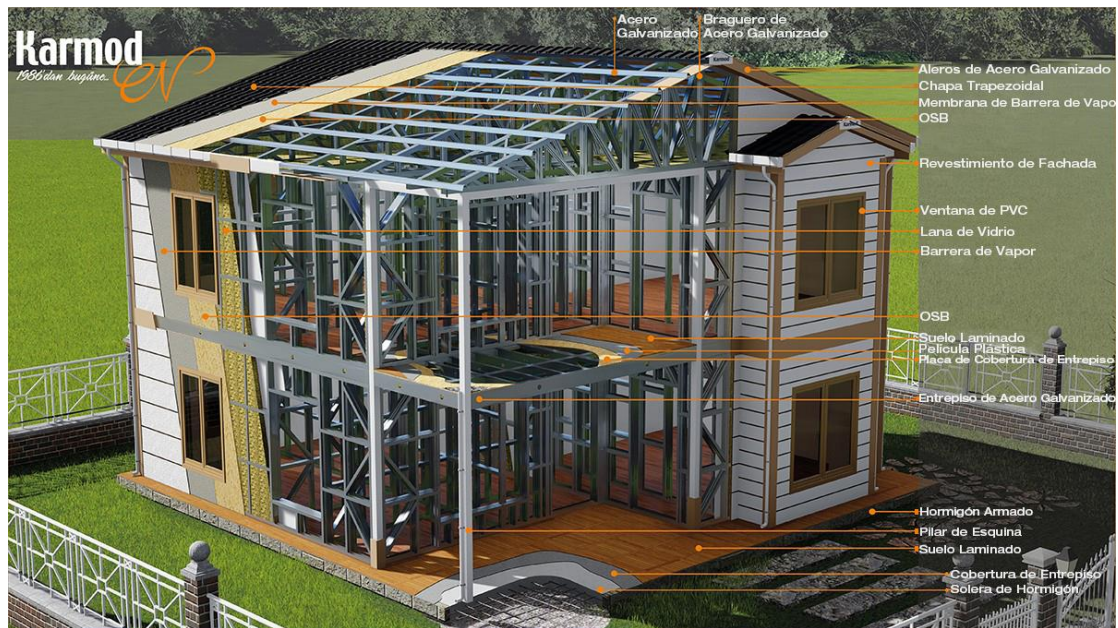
Estructura de una vivienda prefabricada de acero. Fuente: Empresa Karmod.
